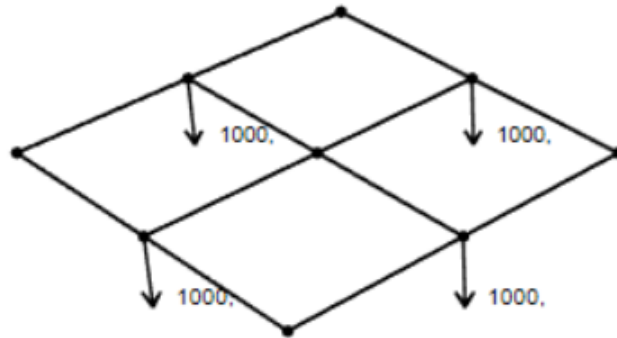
Reacciones aplicando una carga distribuida (P) sobre las vigas
